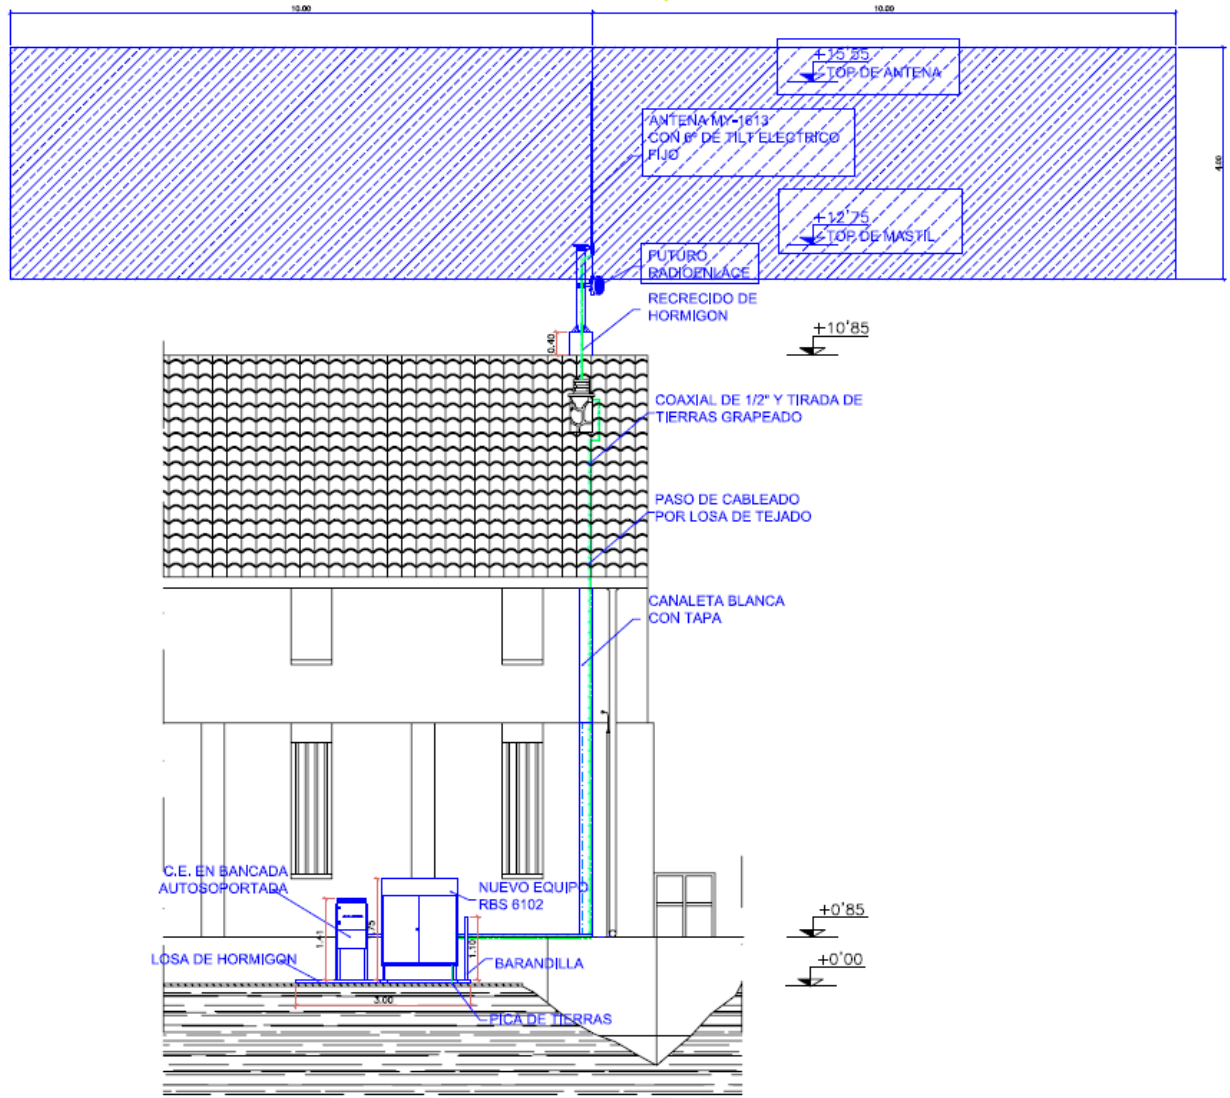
Detalle del alzado de la antena y equipos a colocar en el emplazamiento de ILUNDAIN EB con paralelepípedo según Ley Foral 10/2002 (paralelepípedo de 10 x 6 x 4 m)
